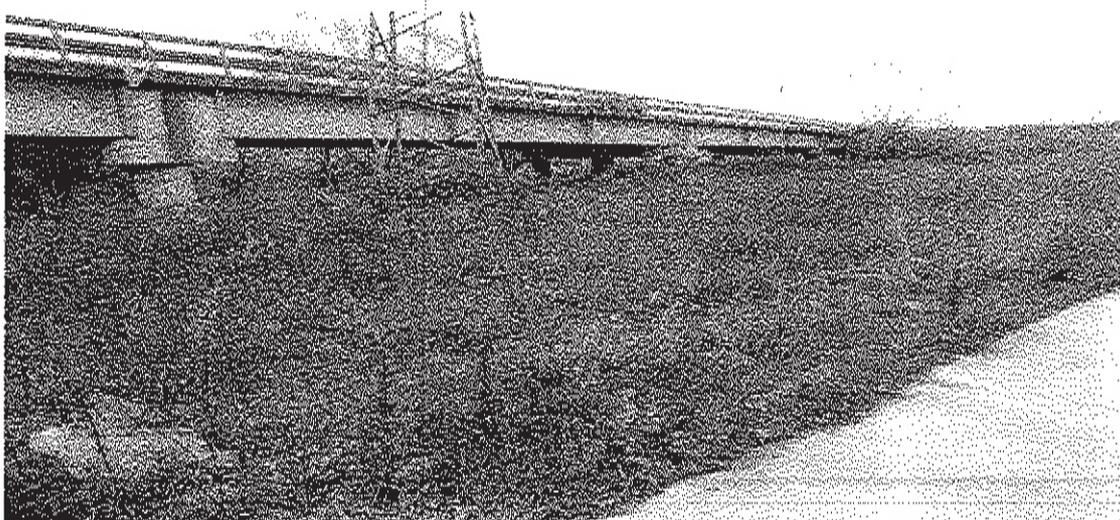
area a verde parte laterale il capannone aziendale e viadotto
